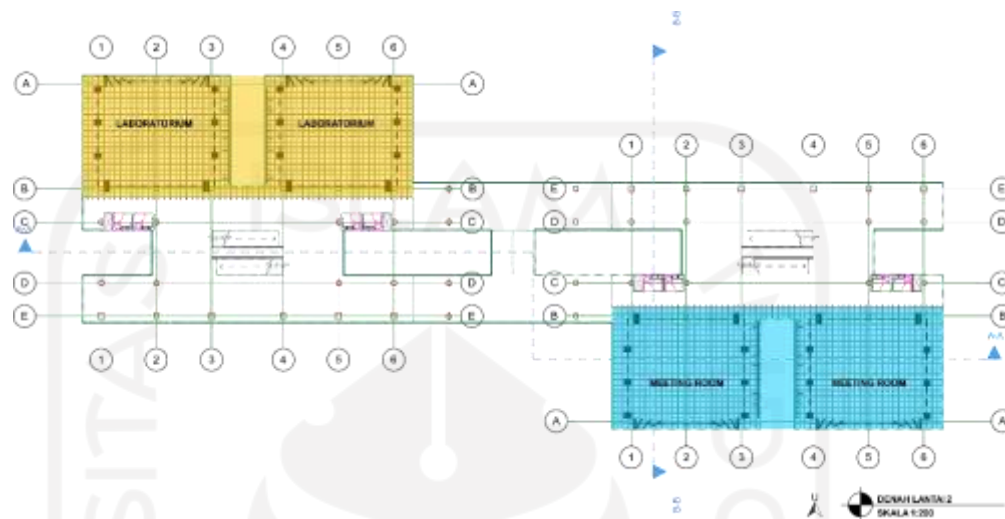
55 Denah Modul Bangunan Bersama Lantai 1
